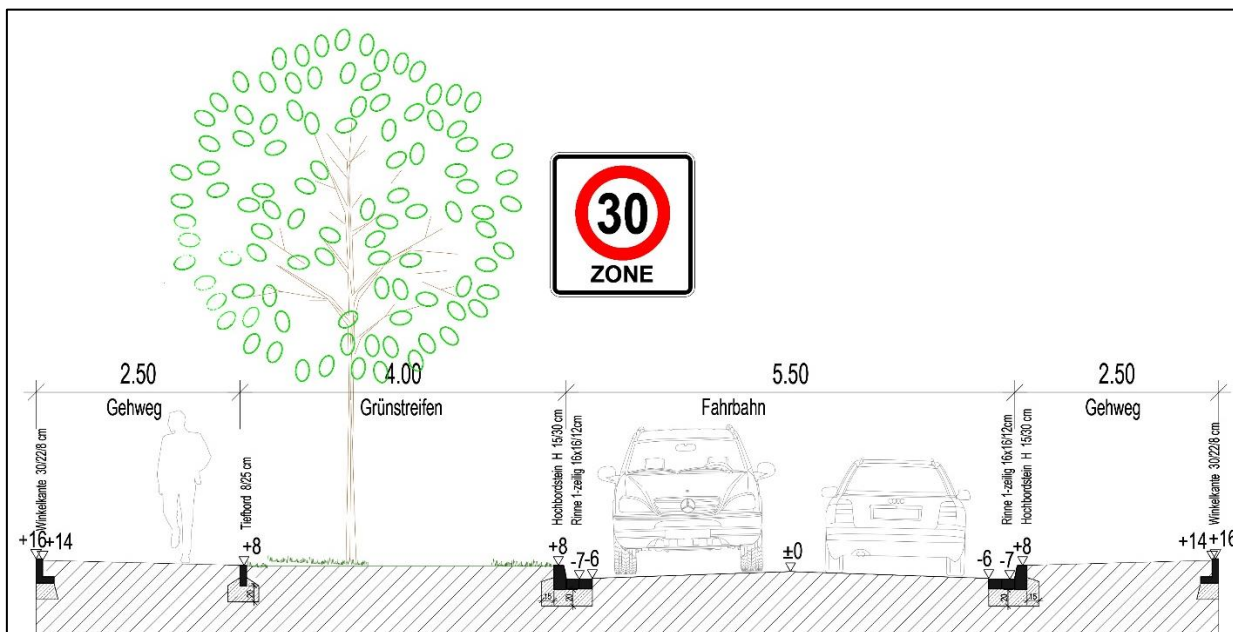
Querschnitt Planstraße B (Ibak Ingenieure, Senden - Mai 2025)
